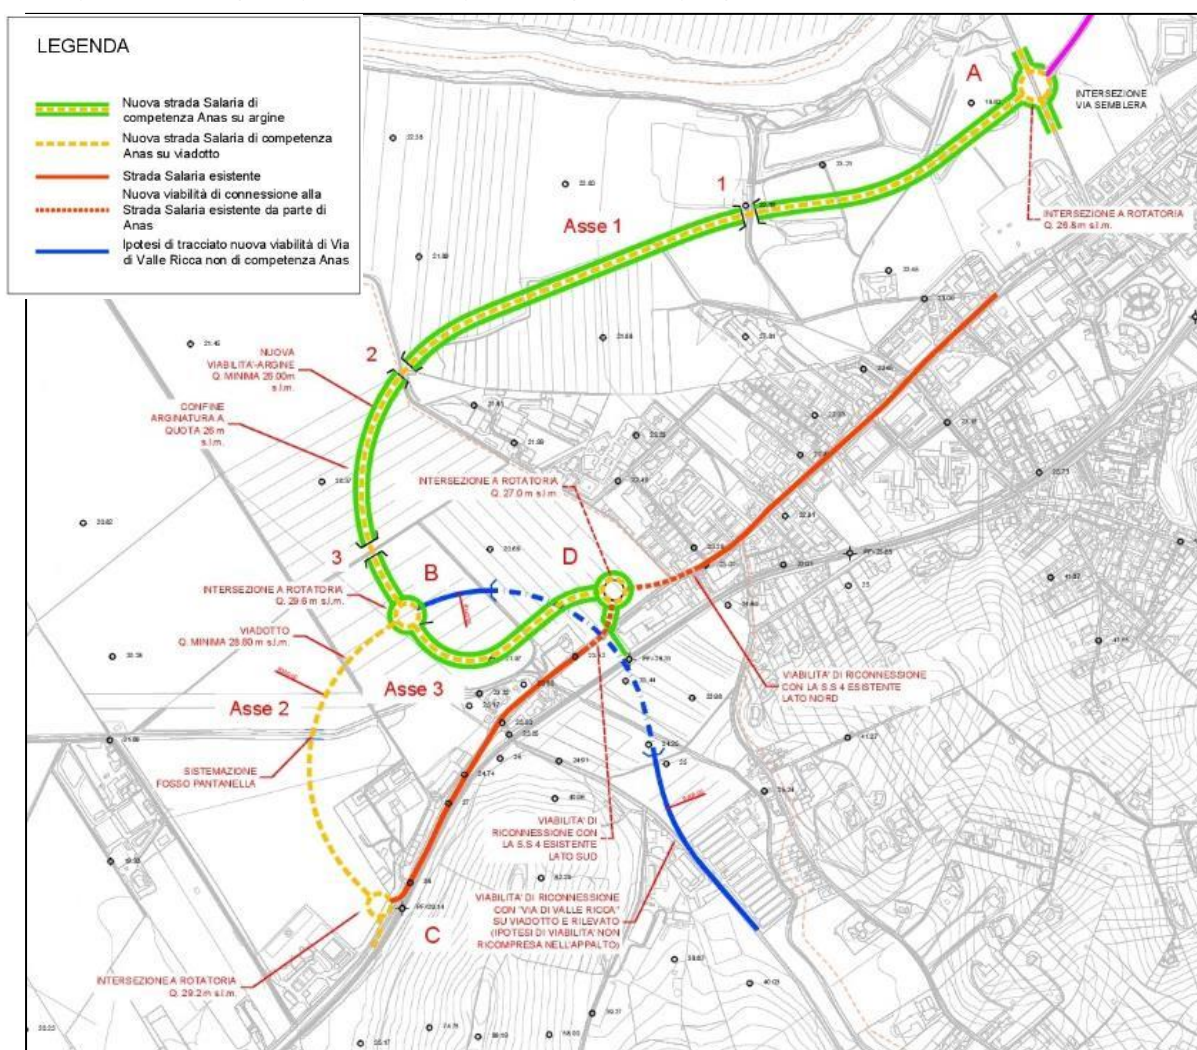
Soluzione alternativa 2 di progetto: Planimetria
